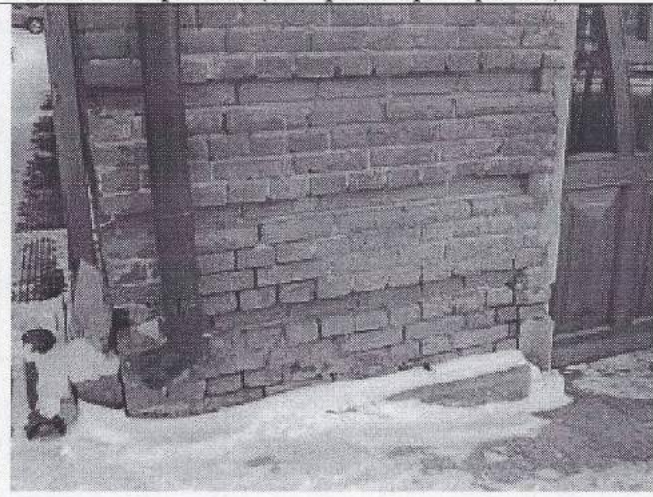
Дефекты кирпичной кладки стены восточного фасада (северная пристройка)
